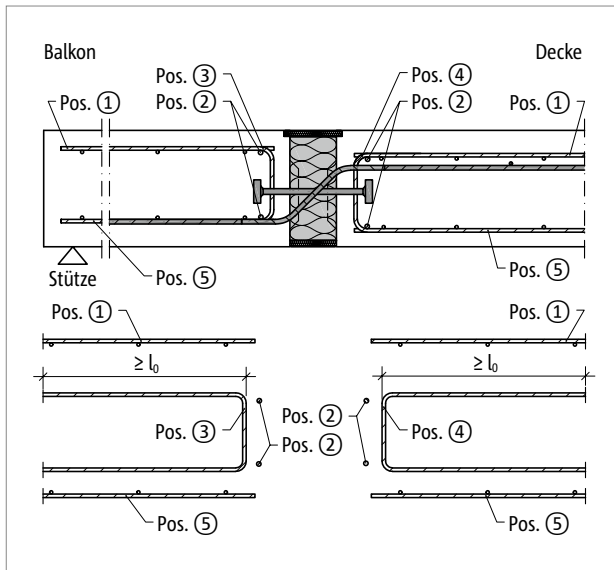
Schöck Isokorb® T Typ QP: Bauseitige Bewehrung
